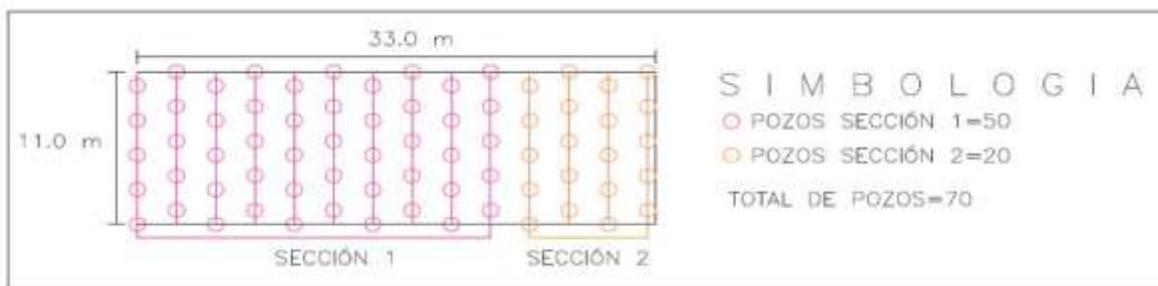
Distribución de los pozos para la restauración de suelo contaminado con HFL y BTEX
